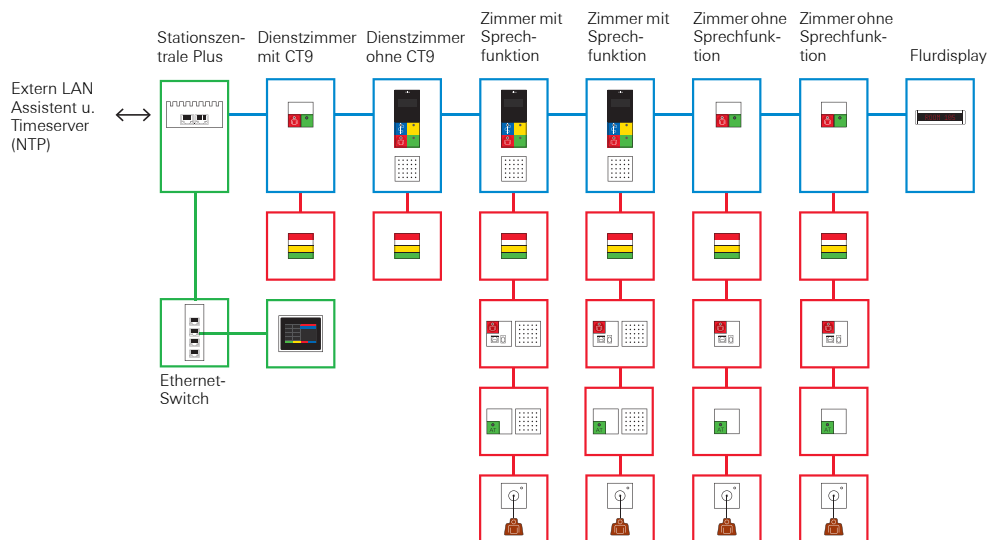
Kleinanlage mit einer Stationszentrale, Switch und Control 9 Dienstzimmerterminal Plus
